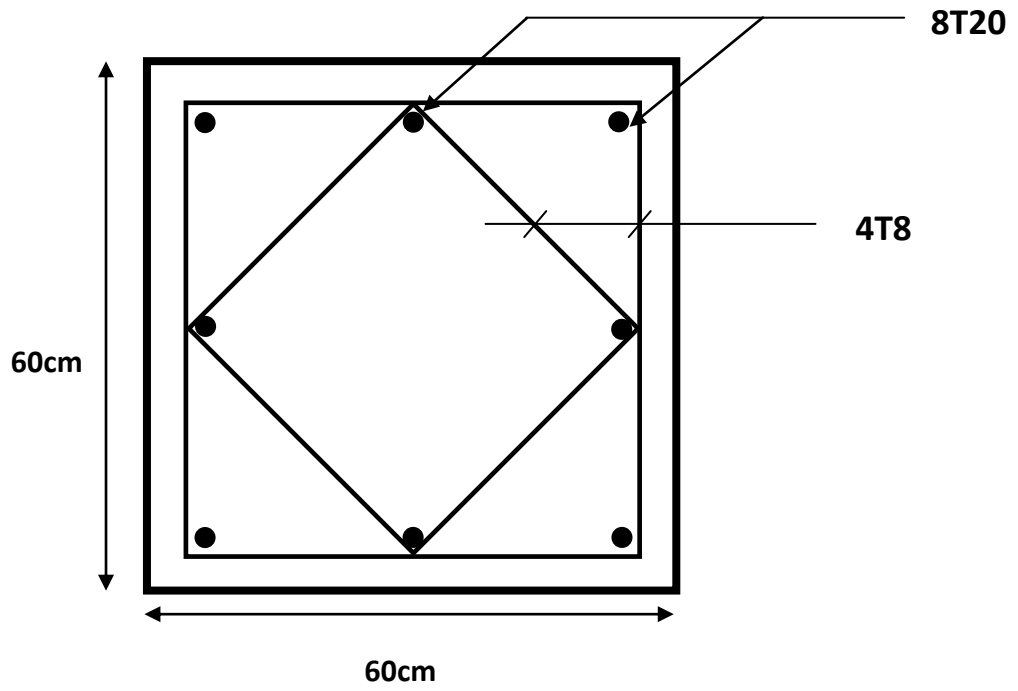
Ferrailage des poteaux de sous-sol (60x60)
